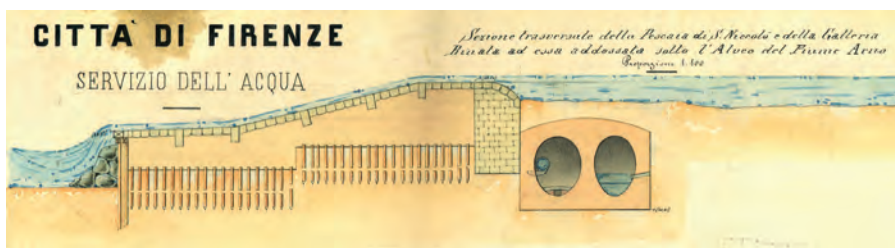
Sezione trasversale della galleria binata e della Pescaia di San Niccolò
